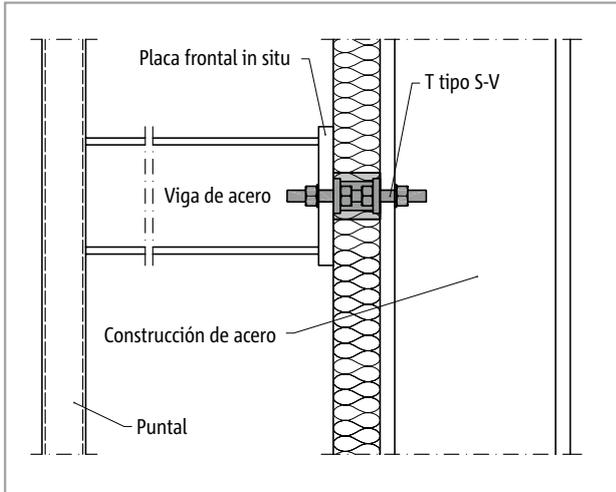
Schöck Isokorb® T tipo S-V: Construcción de acero apoyada
